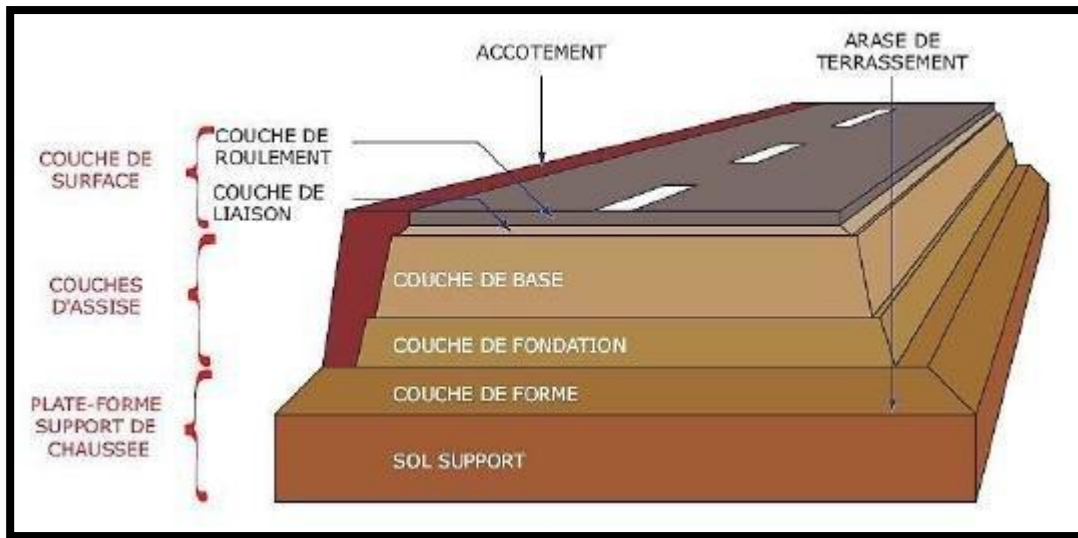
Coupe type d'une structure de chaussée et terminologie des différentes couches
